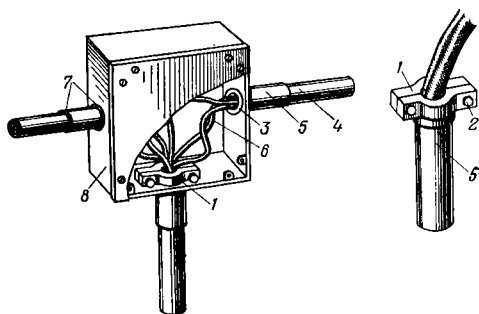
Протяжная (переходная) коробка проводов из вертикальной защитной трубы.
